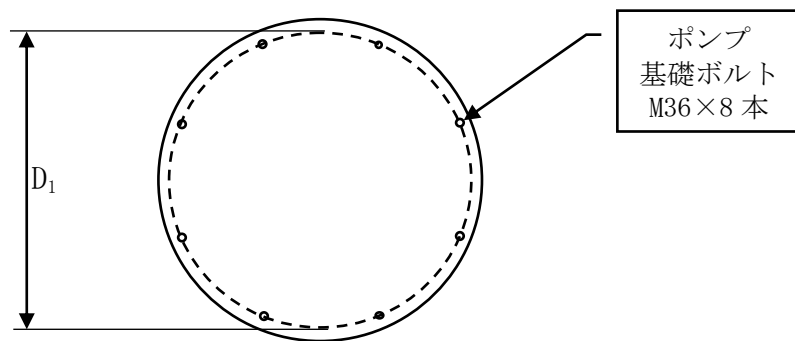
原子炉補機冷却海水ポンプ，ポンプ基礎ボルト配置
